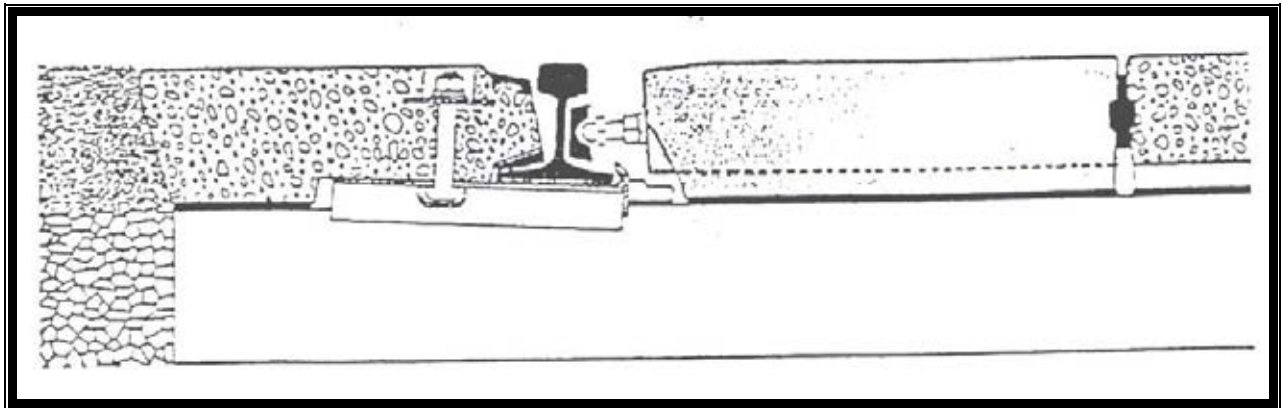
Superficie de Rodadura Elementos Prefabricados de Hormigón Armado
